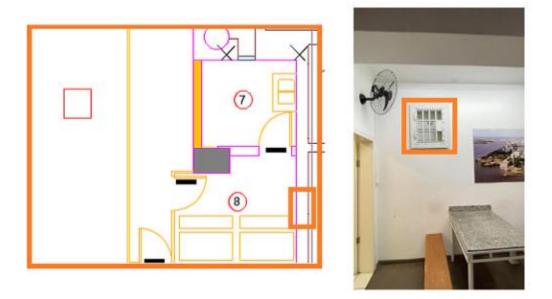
Parede em frente ao antigo cofre a ser removida, verificar se de alvenaria 4.4.2. Rebaixo existente no banheiro de acesso privativo.
